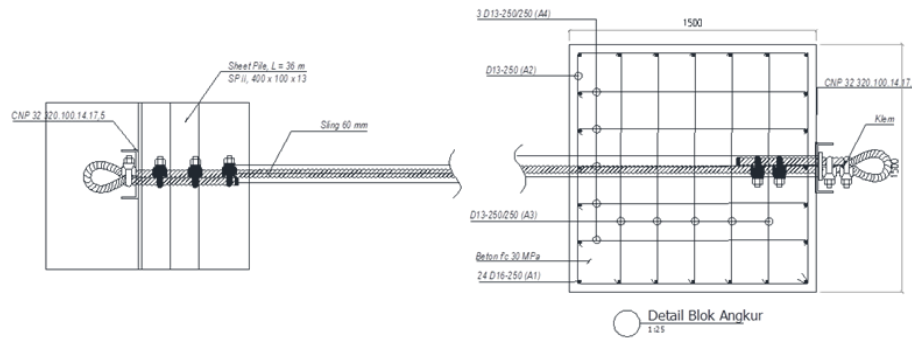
Tipikal Penanganan dengan Sheet Pile Baja
